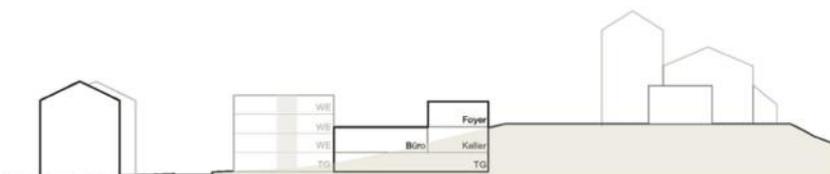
Schemaschnitt Nord-Süd - Variante 3 (ohne Masstab)
